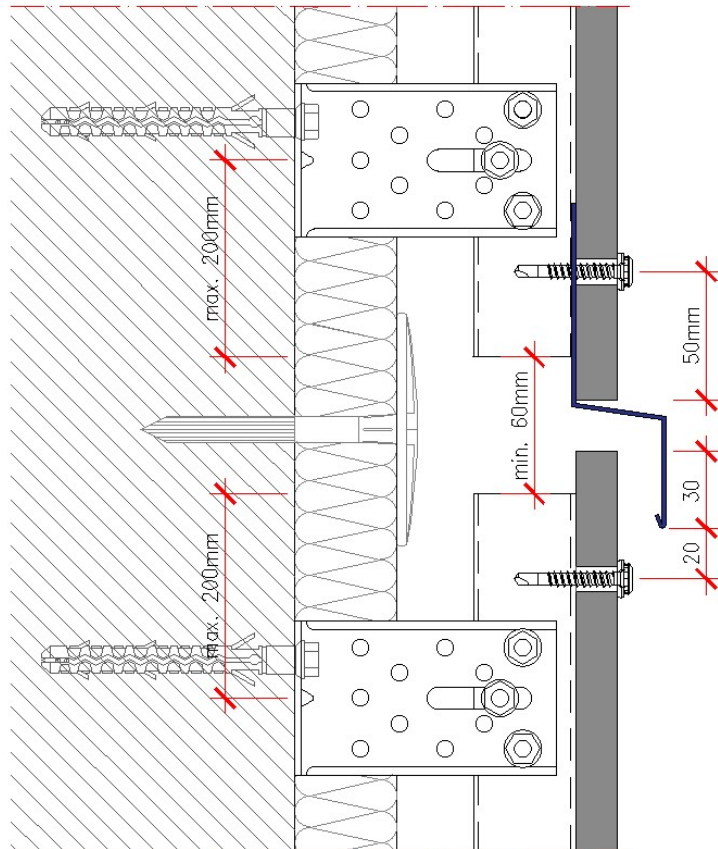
Fracionamento da estrutura: Perfis com comprimento  $> 6$  m
